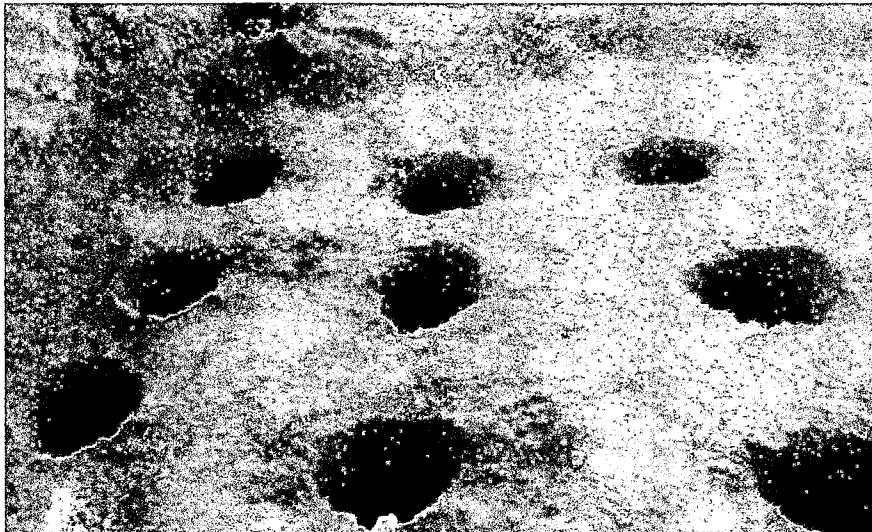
CONSTRUCCION PILOTINES DE CAL
